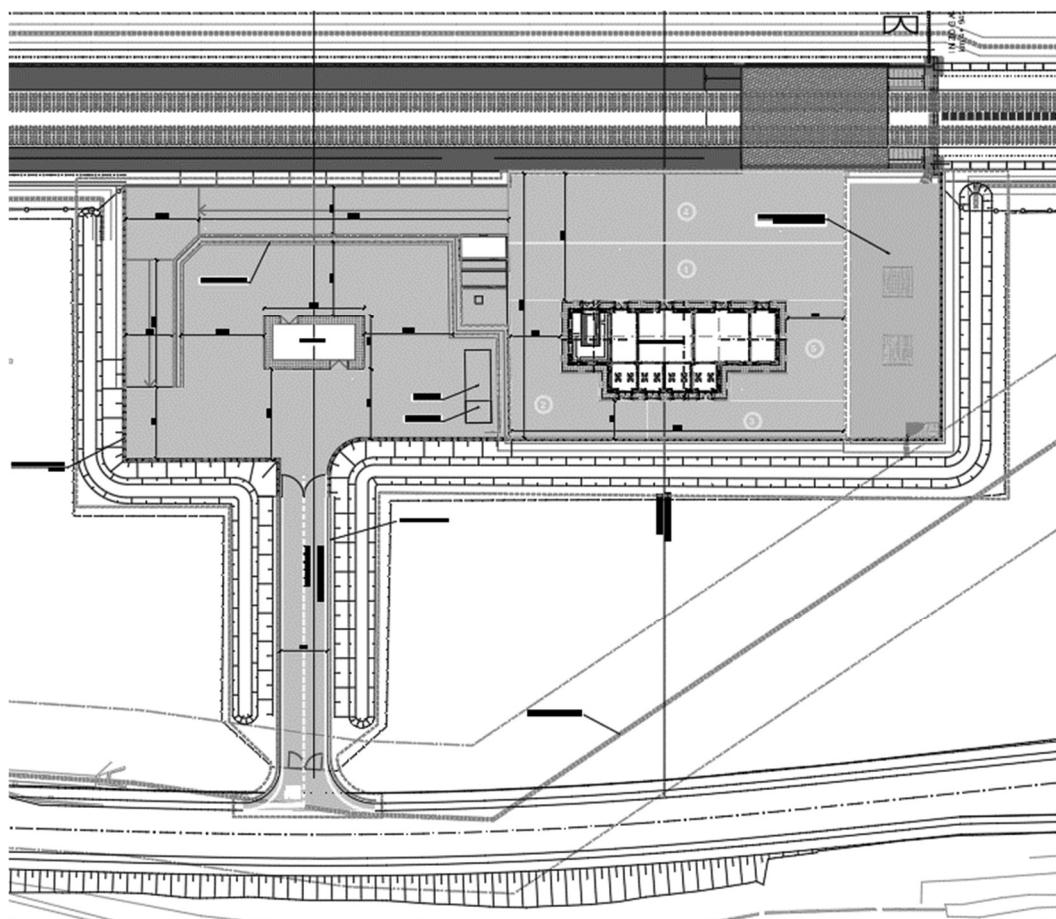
Estratto planimetrico dello stato di progetto – Individuazione dell'area oggetto di intervento con polilinea tratteggiata nera (piazzale e viabilità di accesso).
